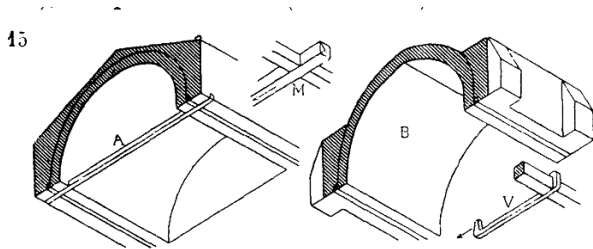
Detalles de Choisy similares a los de Viollet con carreras embebidas en arranque de bóvedas y ganchos para atirantado temporal durante la construcción. Choisy's details similar to Viollet's ones of temporary tighten (30).
